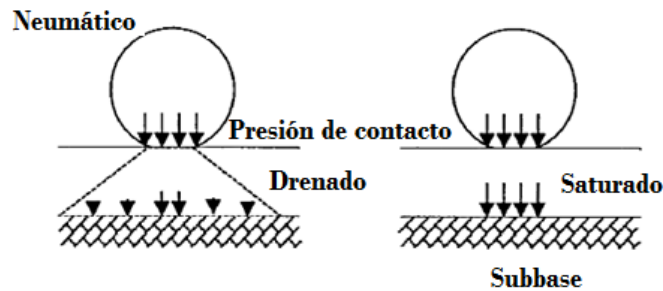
Distribución de los esfuerzos en capas del pavimento flexible drenadas y saturadas.
